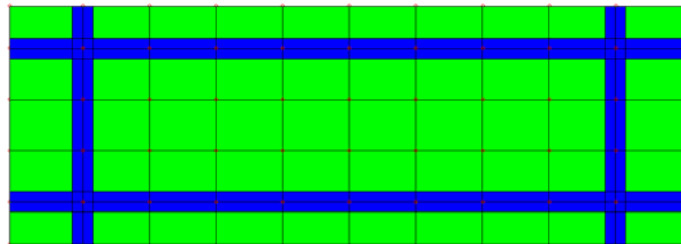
Vista in Pianta Platea e Travi di Fondazione
